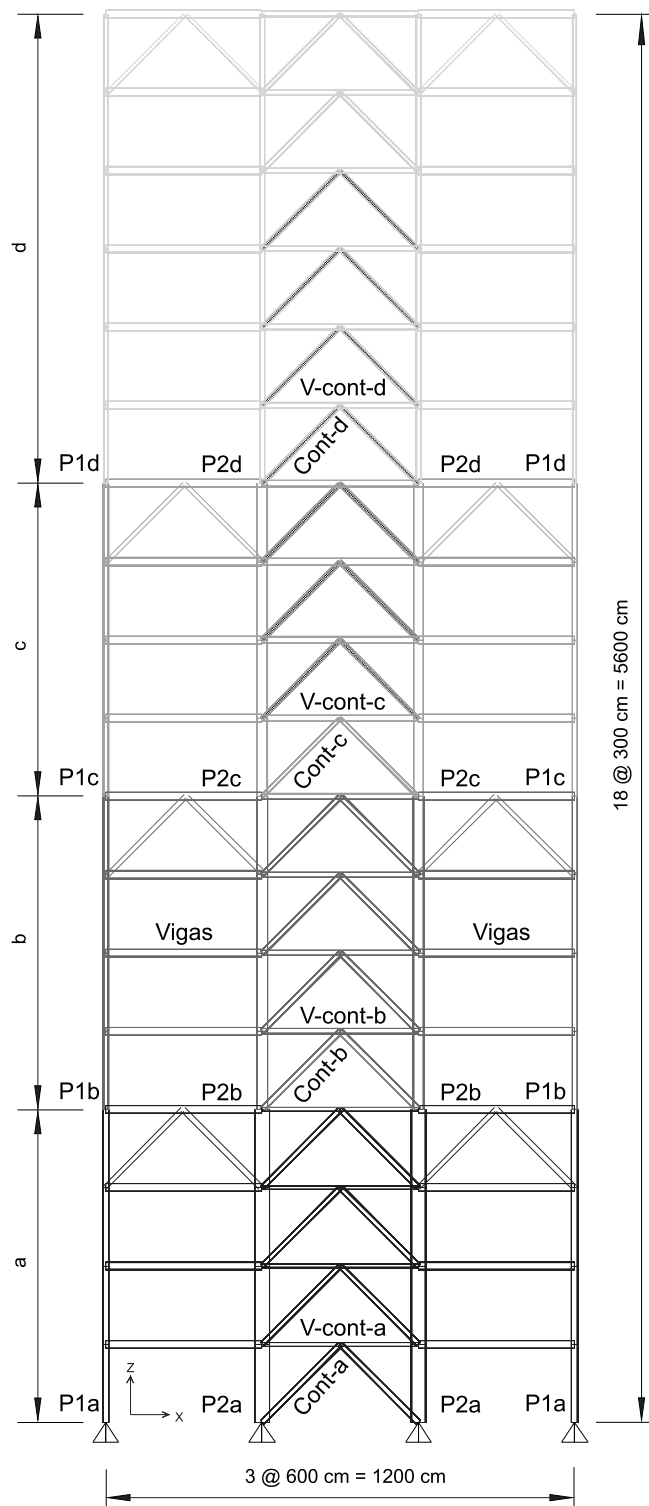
Caso 4 – Pórtico B contraentado de 18 pavimentos.
